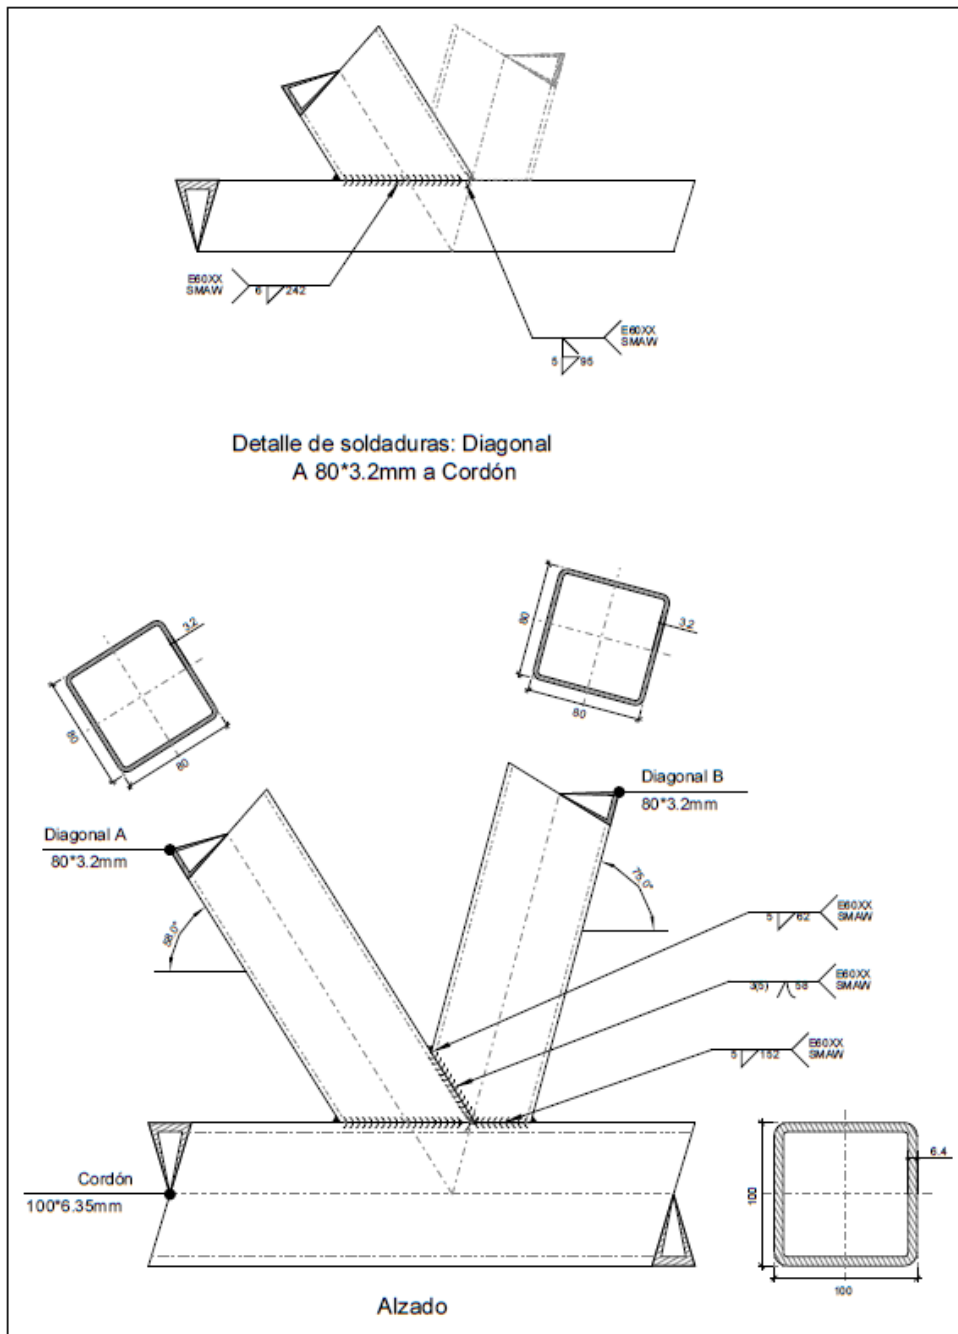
| Detalle de unión de cabreada y viga principal
